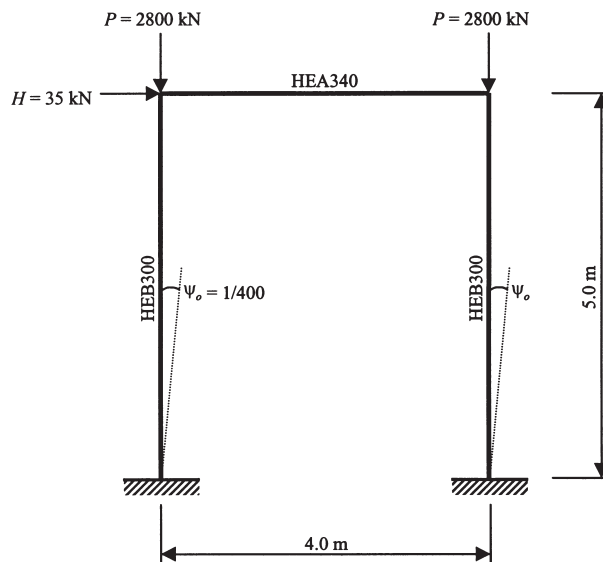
Geometria e carregamento do pórtico de Vogel (Avery e Mahendran, 2000)
